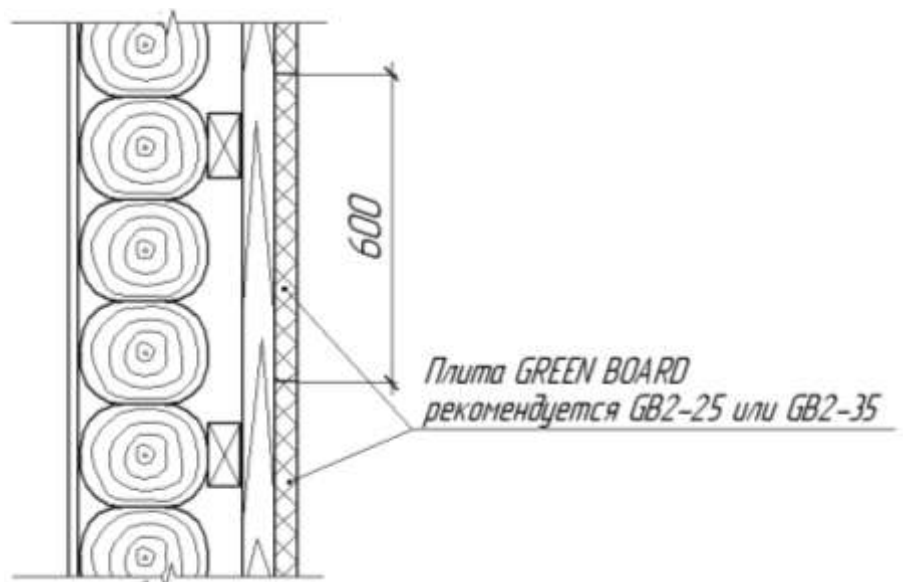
Разрез деревянной стены, со смонтированной несъемной опалубкой
